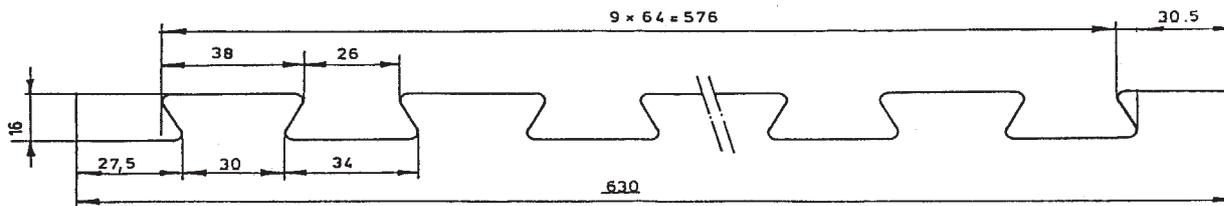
dimensions de la plaque à queue d'aronde (en mm)
